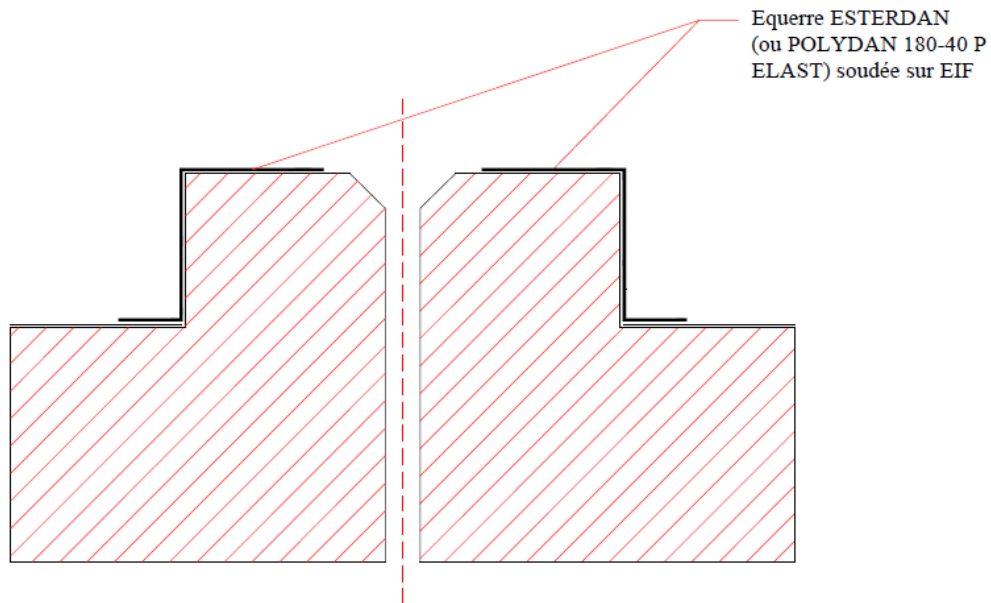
Exemple de joint sur costière sur élément porteur bois, panneaux à base de bois et panneaux CLT
